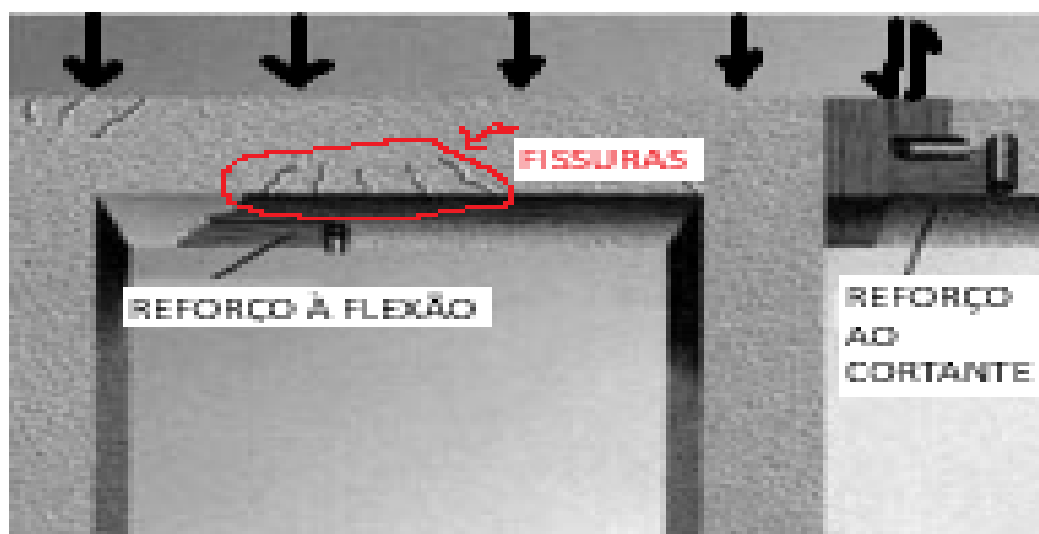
Esquema de reforço de vigas à flexão e ao esforço cortante com combate à fissuração.
